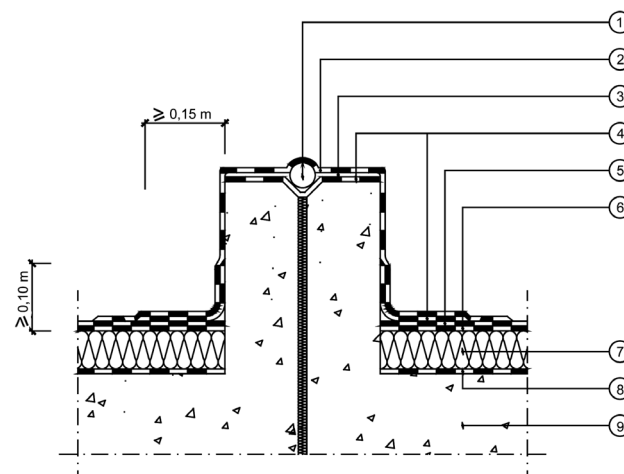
Finition du revêtement d'étanchéité autour d'un élément de toiture émergent
